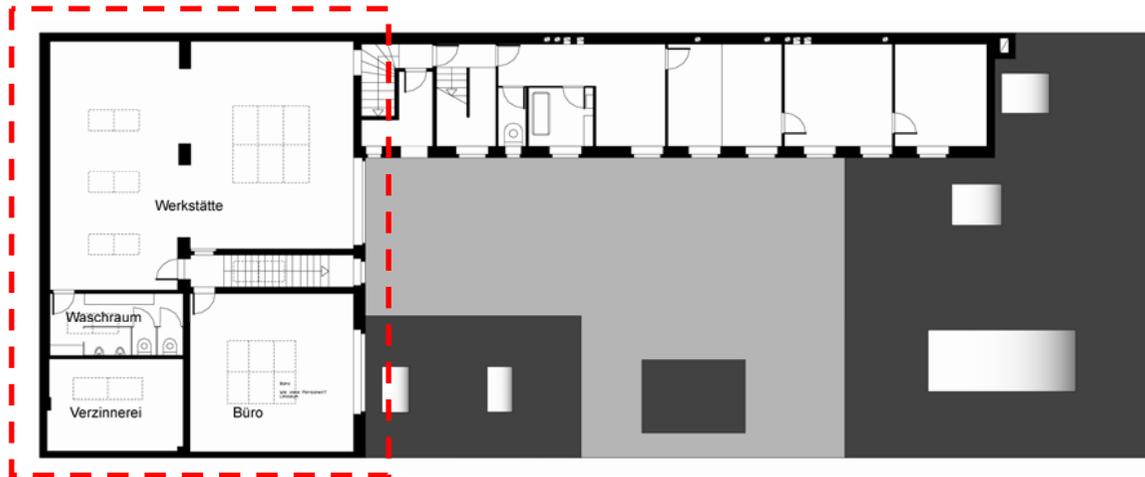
Grundriss erstes Obergeschoss mit Büro und Werkstatt
